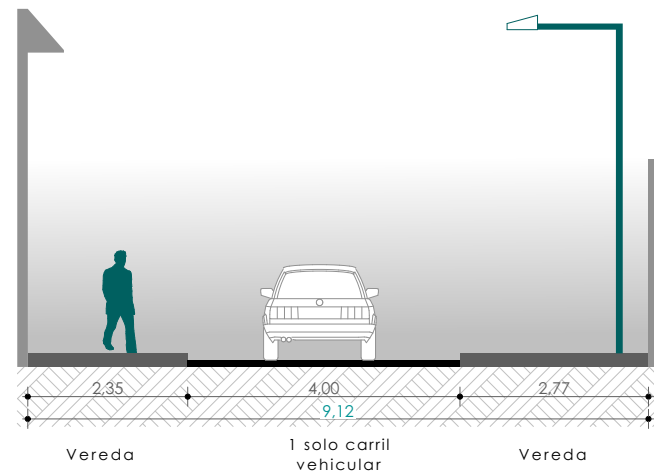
Sección S_02 calle Sucre. Imagen: propia
